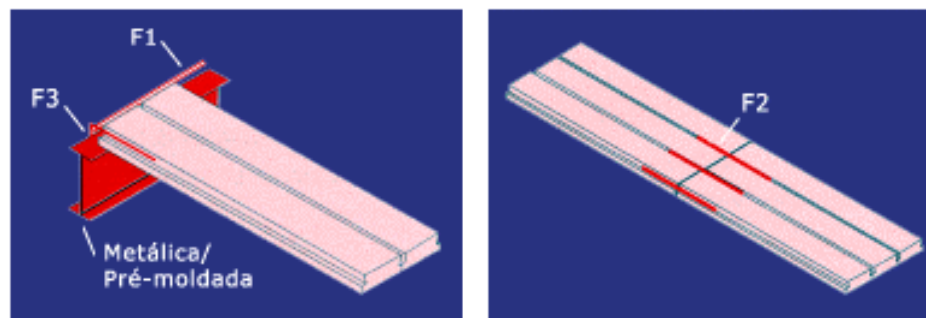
Montagem dos painéis de Laje pré-moldada em CCA
